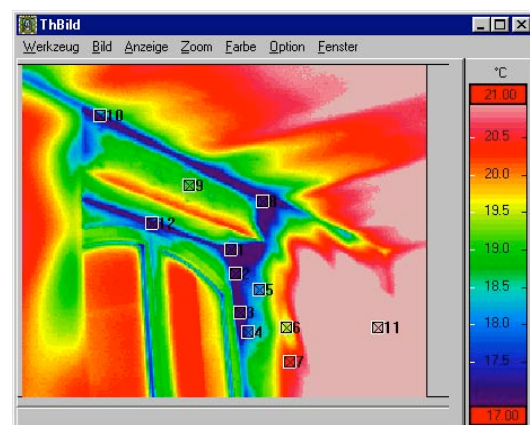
Infrarotaufnahme Erdgeschoss Schlafzimmer: Leckagen beim best. innenliegenden Rolladenkasten und beim Fenster
